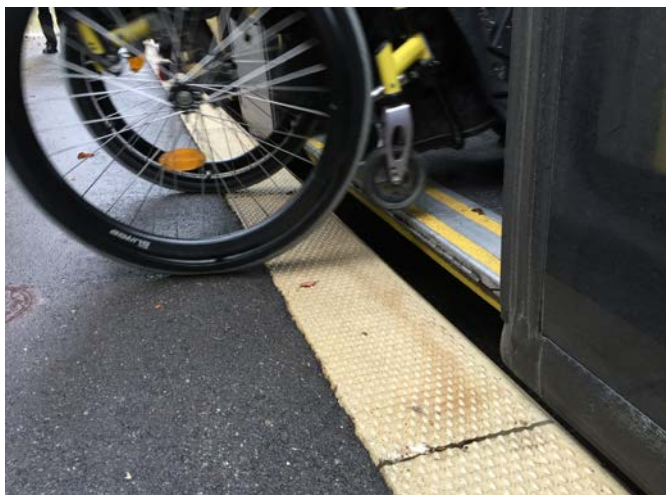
Eine Haltekante mit 22 cm Höhe ermöglicht den selbstständigen Fahrgastwechsel auch für Fahrgäste mit Rollstuhl oder Rollator [Foto: Boenke]
